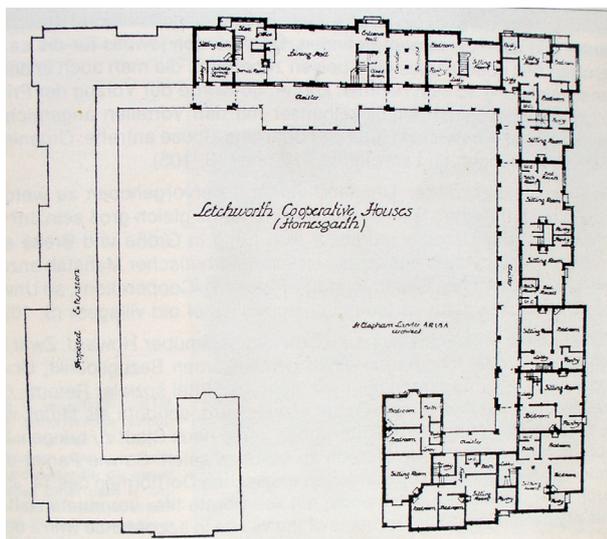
Grundriss Einküchenhaus Homesgarth
